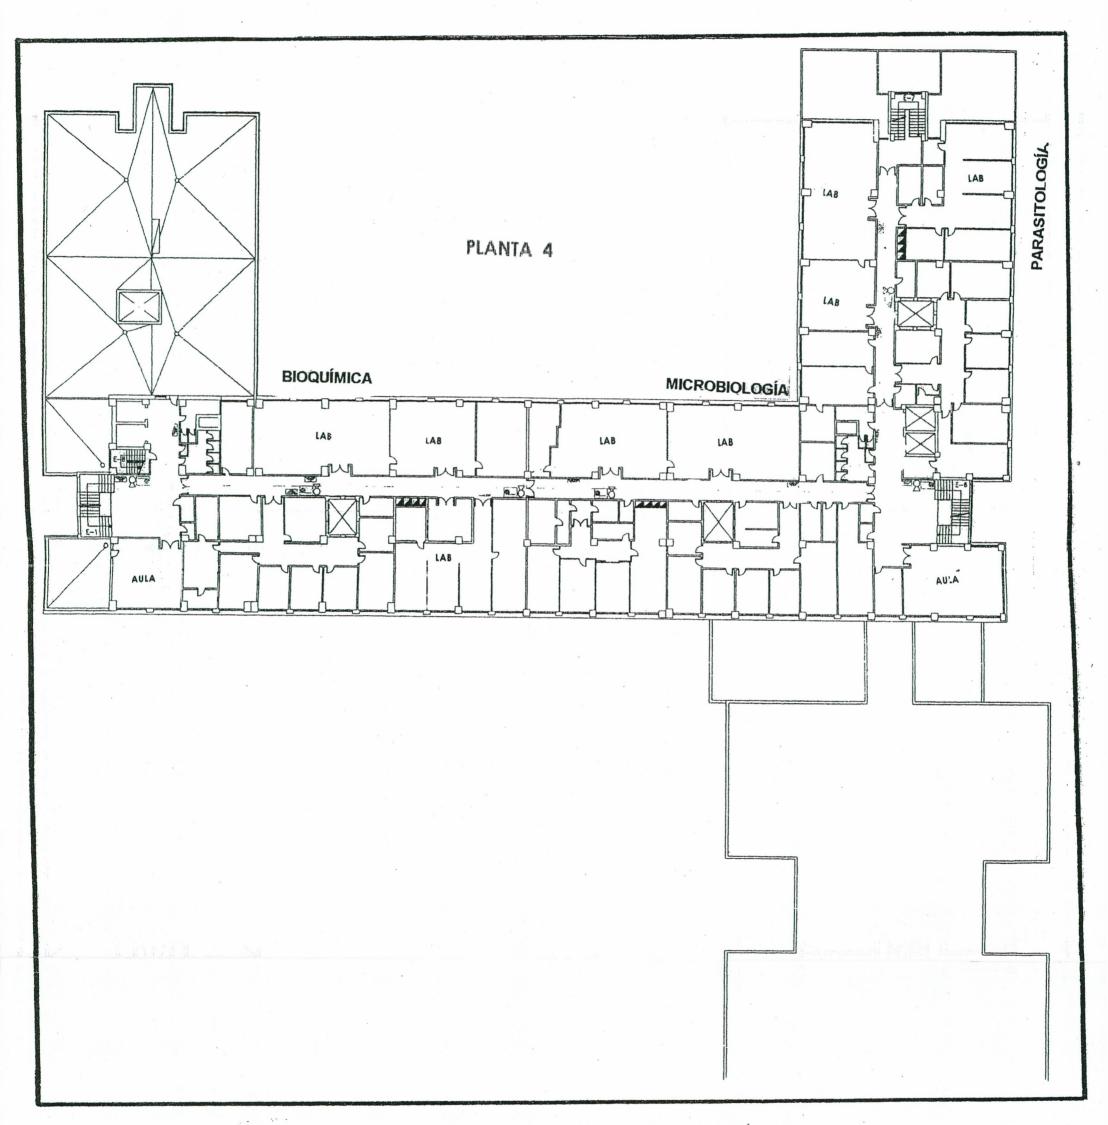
Plano de la Facultaa de Farmacia. Planta 4. FUENTE: SERVICIO DE PREVENCIÓN. UGR.
